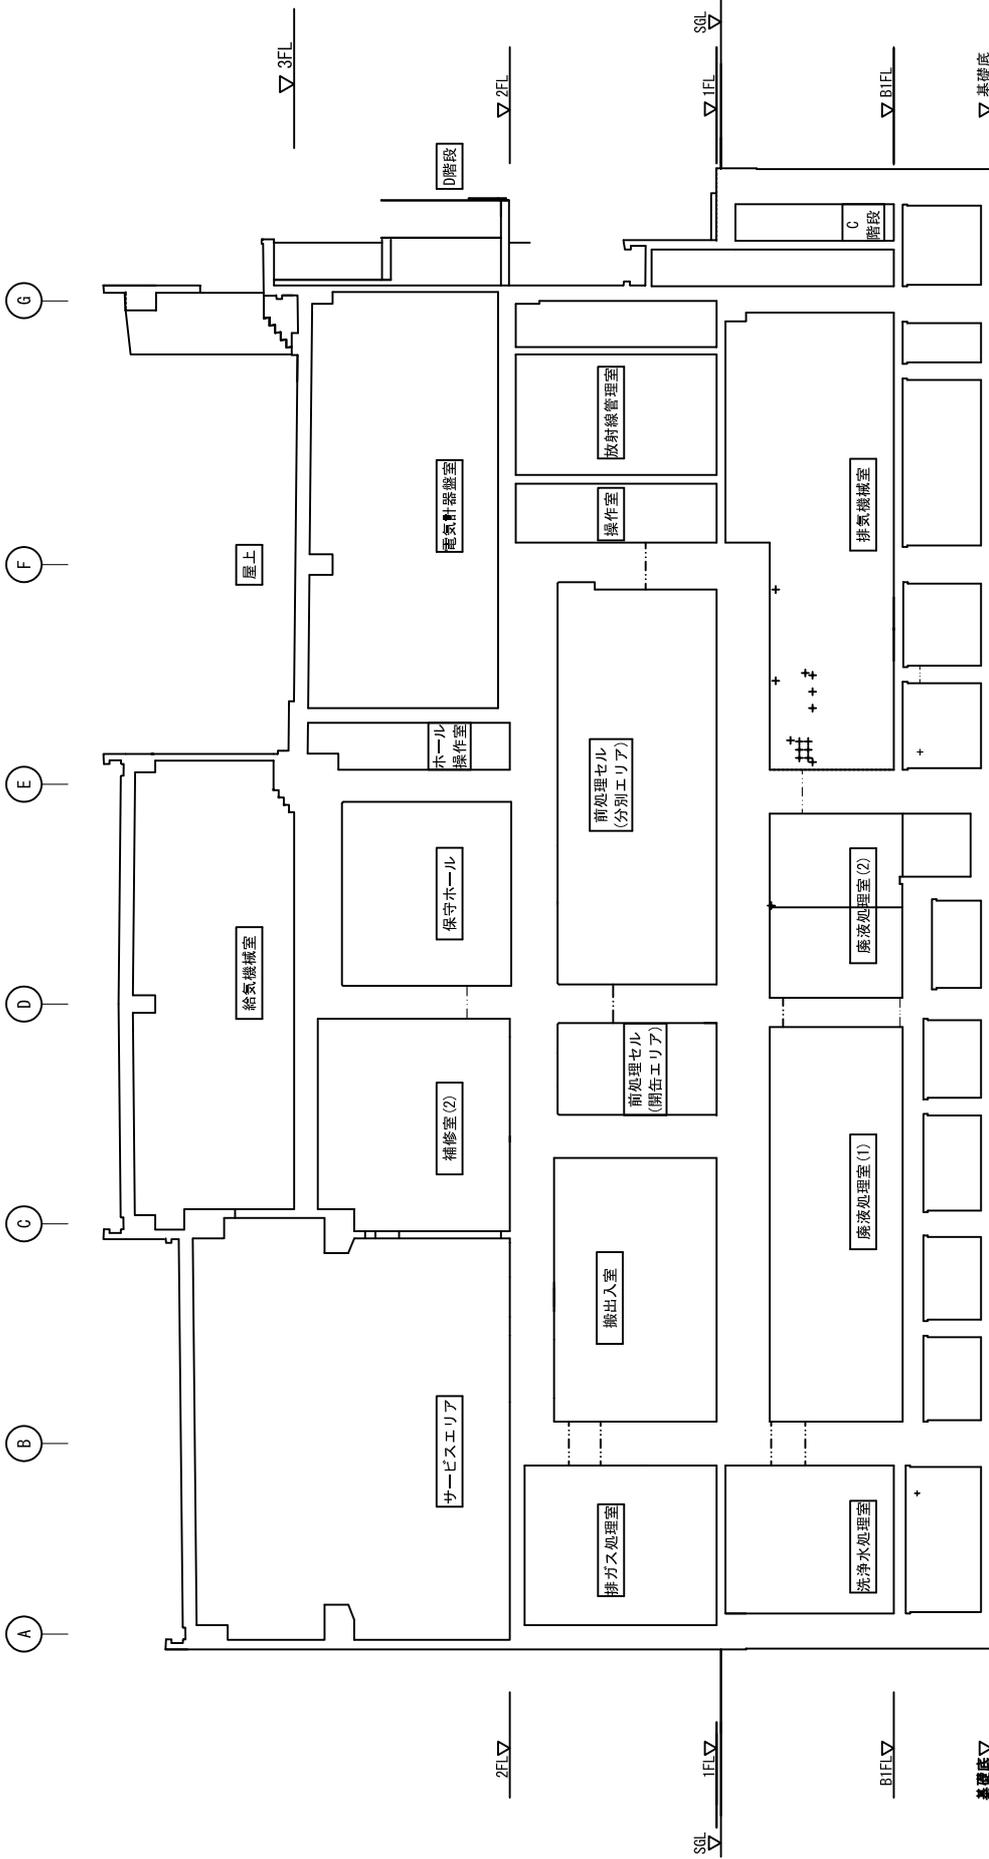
固体廃棄物減容処理施設 貫通孔配置図 (①~②間断面図 (2))
